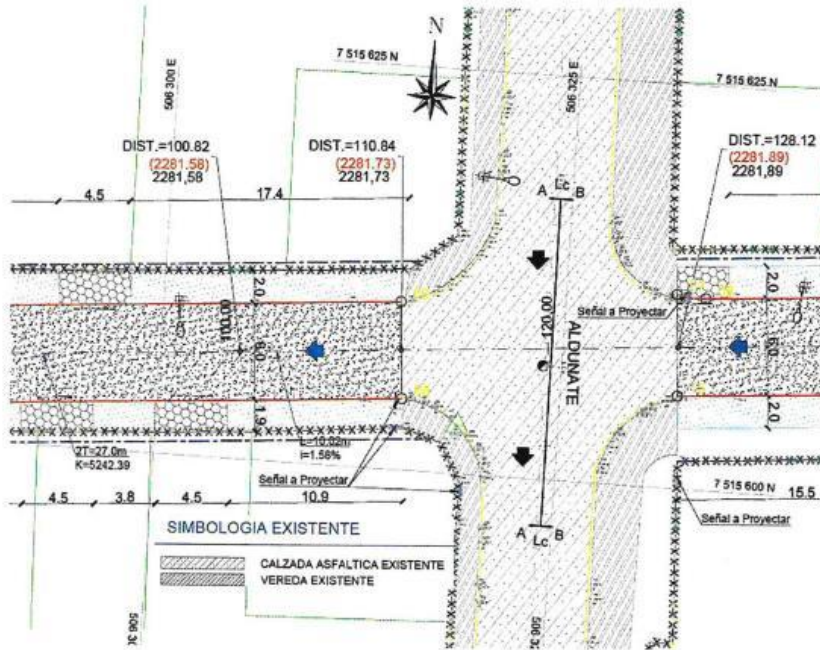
Intersección de calle Javiera Carrera con calle Aldunate proyectada, donde se mantienen aceras de hormigón y soleras tipo A existentes.
